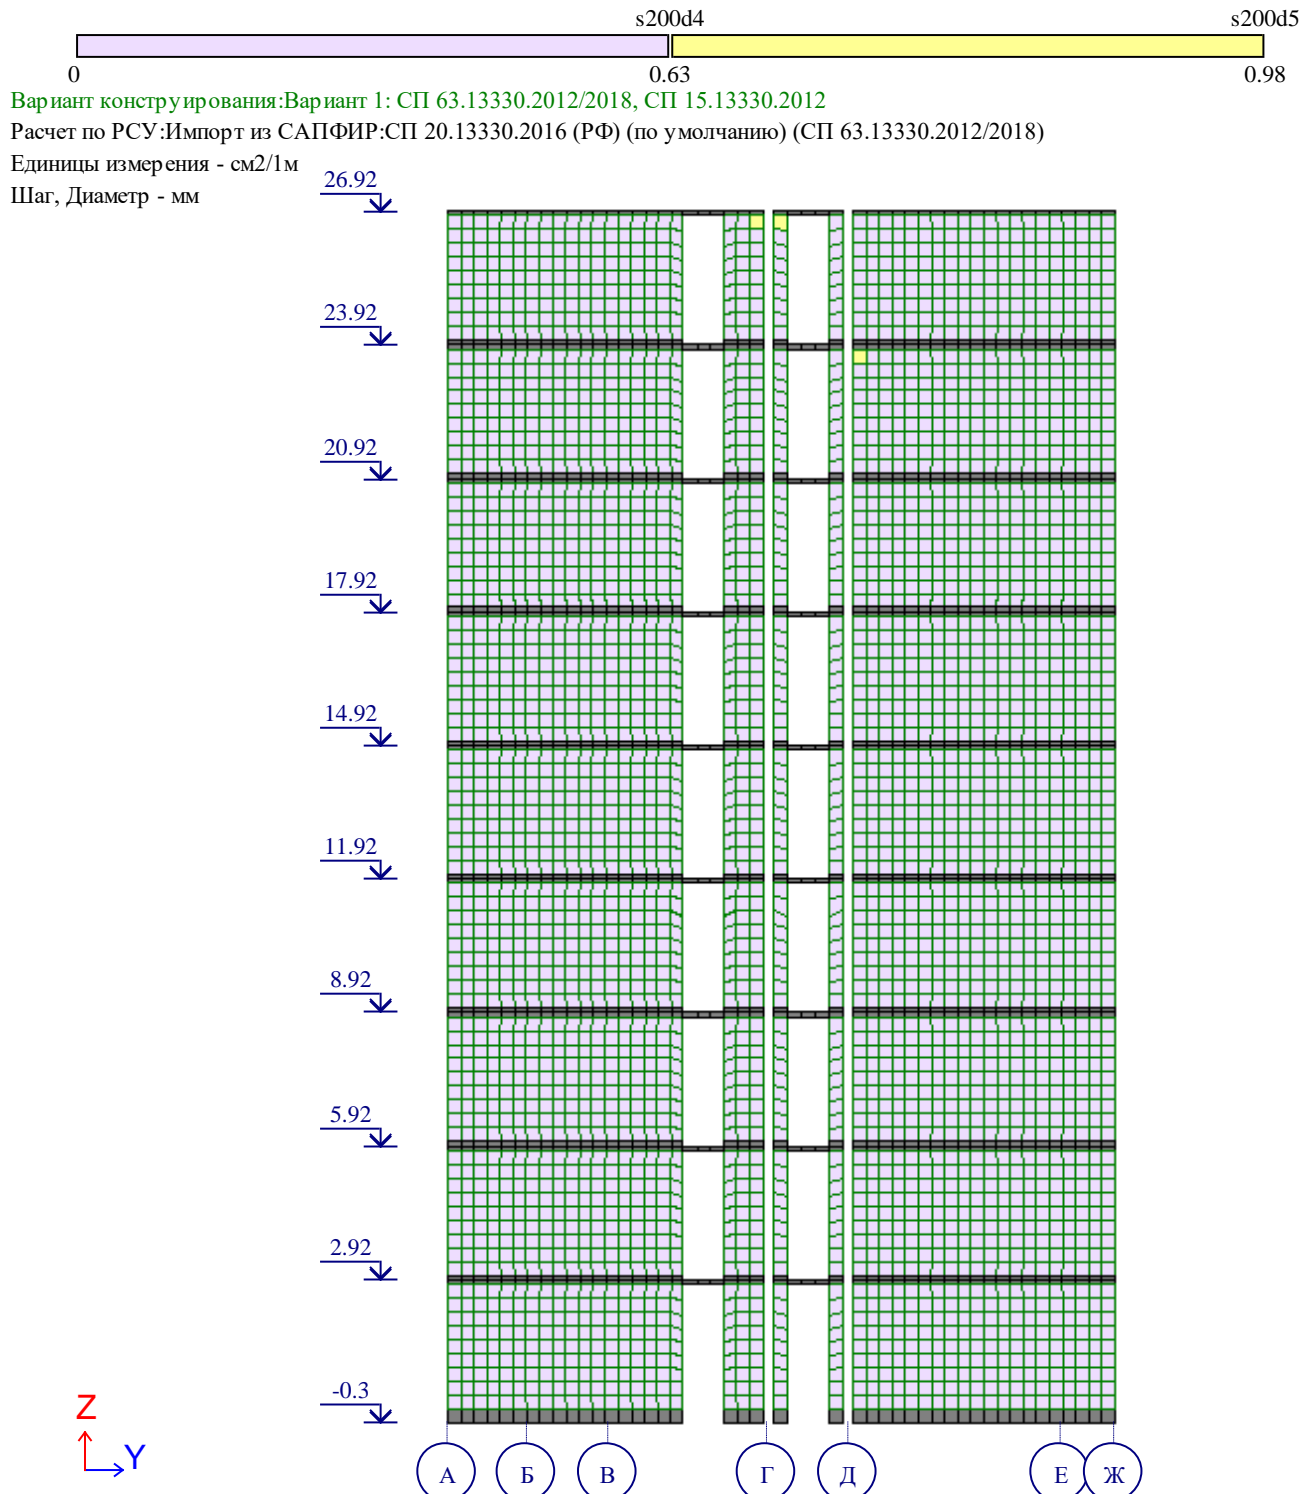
Площадь поперечной арматуры в см² на 1м²
